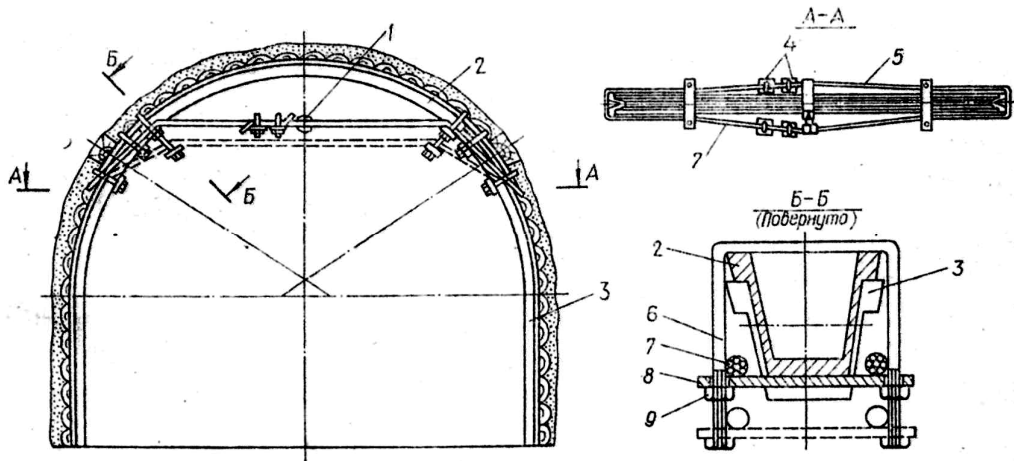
Конструкция стяжки для усиления арочной крепи
